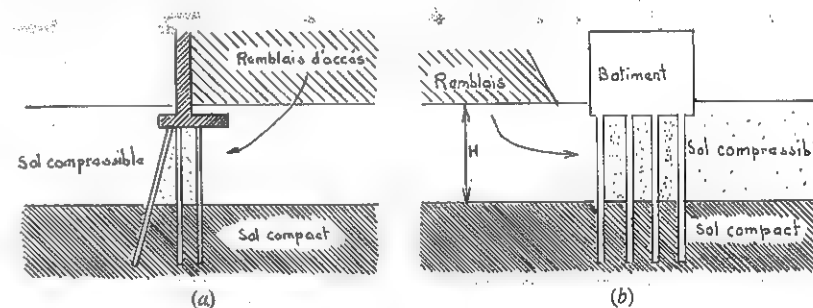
Poussées horizontales provoquées par un remblai construit sur sol compressible.
